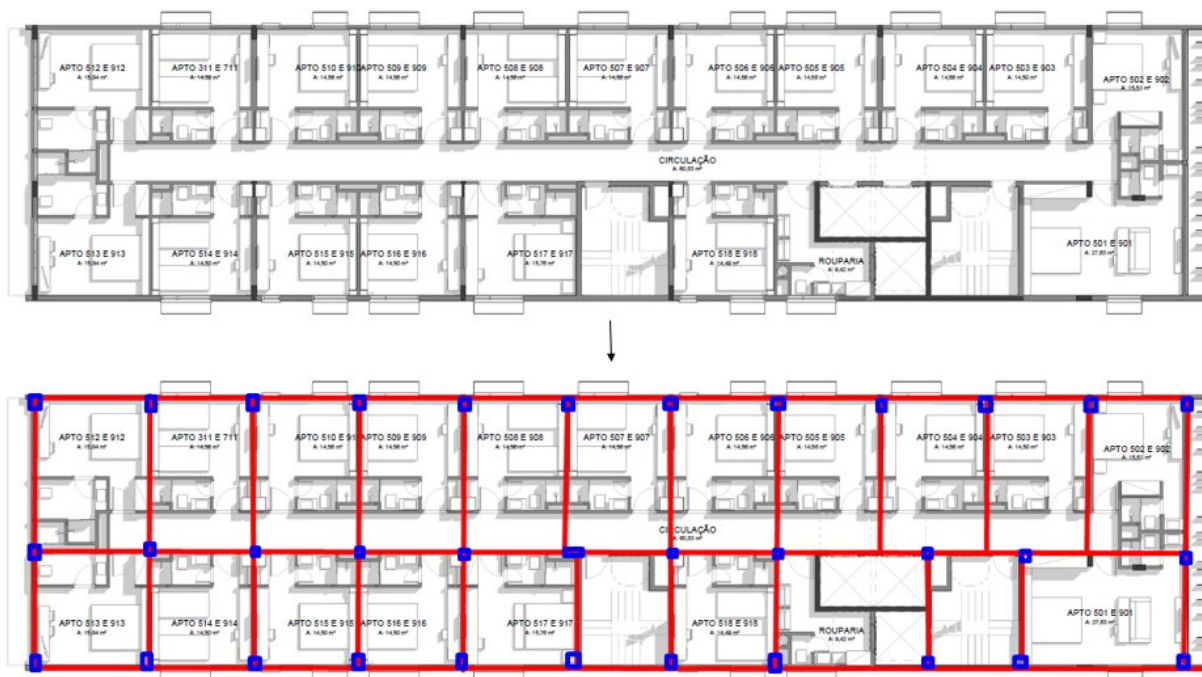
Concepção preliminar da estrutura (Fonte: Autor, 2023)
